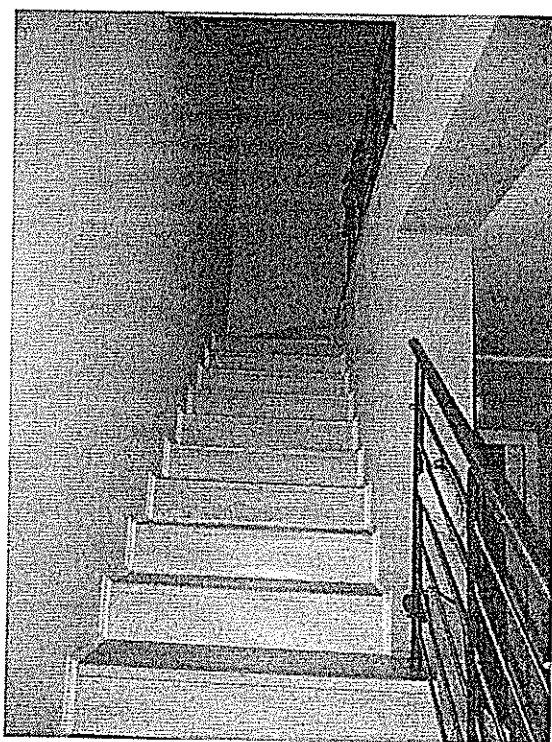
LOTTO B2: visione interna - scala accesso al piano primo
